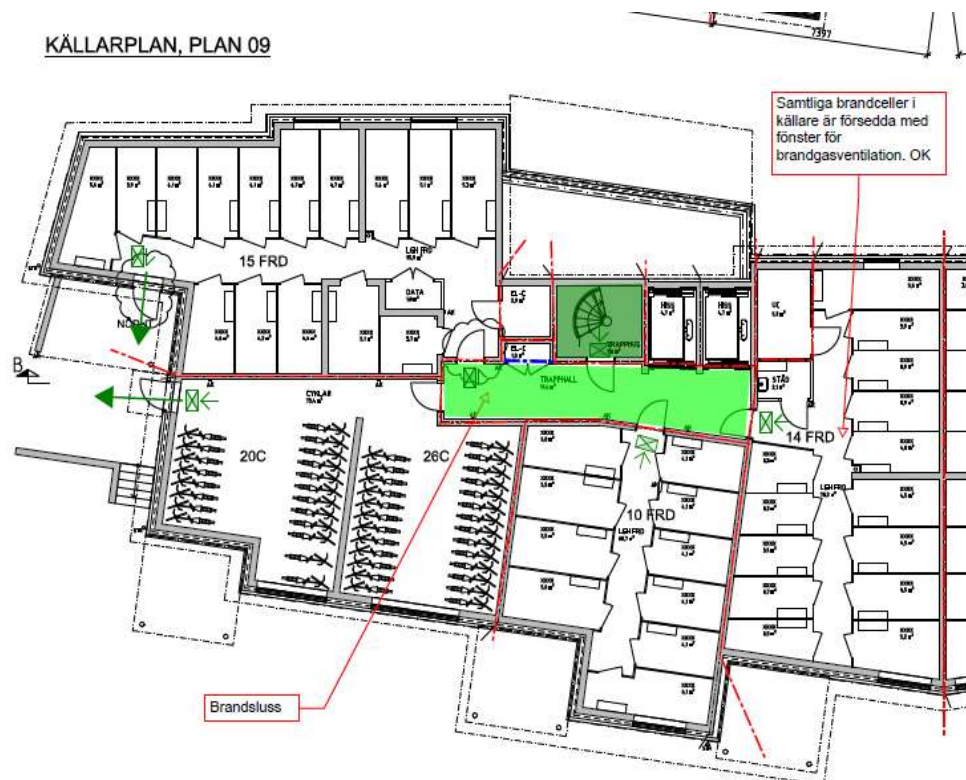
Källarplan (urklipp ur bygglovshandlingarna, ej skalenlig).
